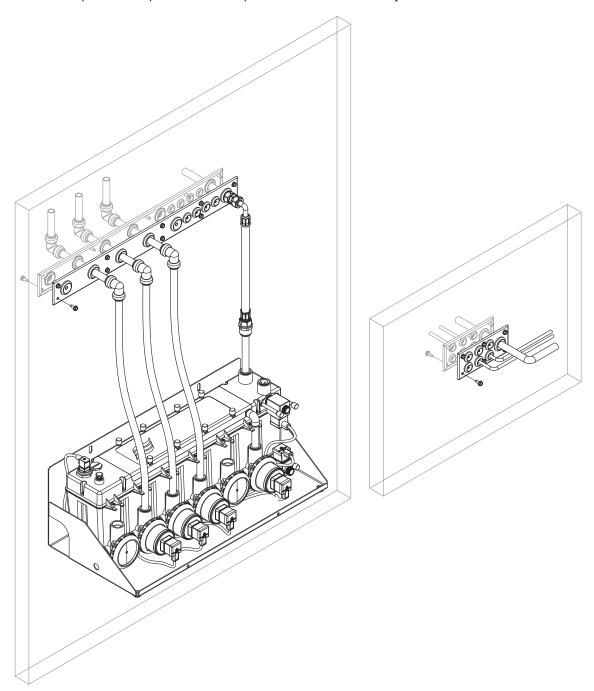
Fijación de la placa con pasamuros a la pared del conducto (instalación externa)
